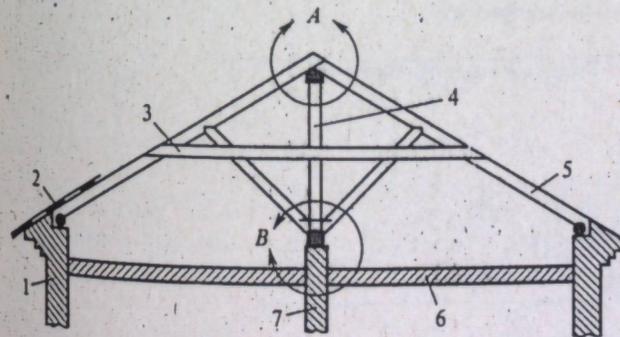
Строительная конструкция (А и В — узлы соединения элементов)
